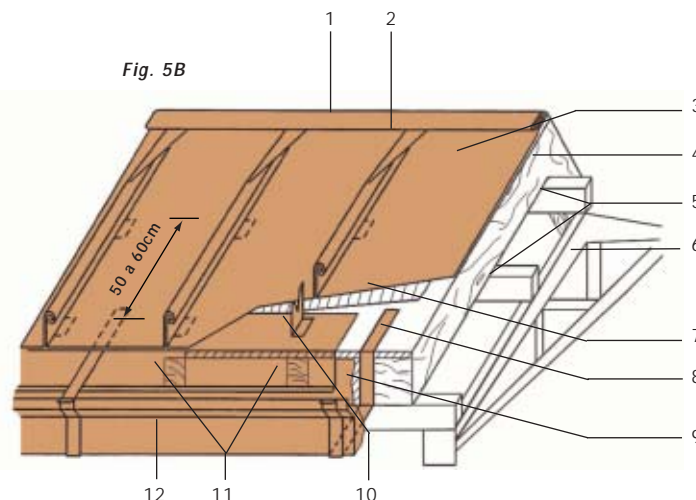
B - Suporte base de madeira (aglomerado / compensado) sobre estrutura de madeira (tesouras / terças).
